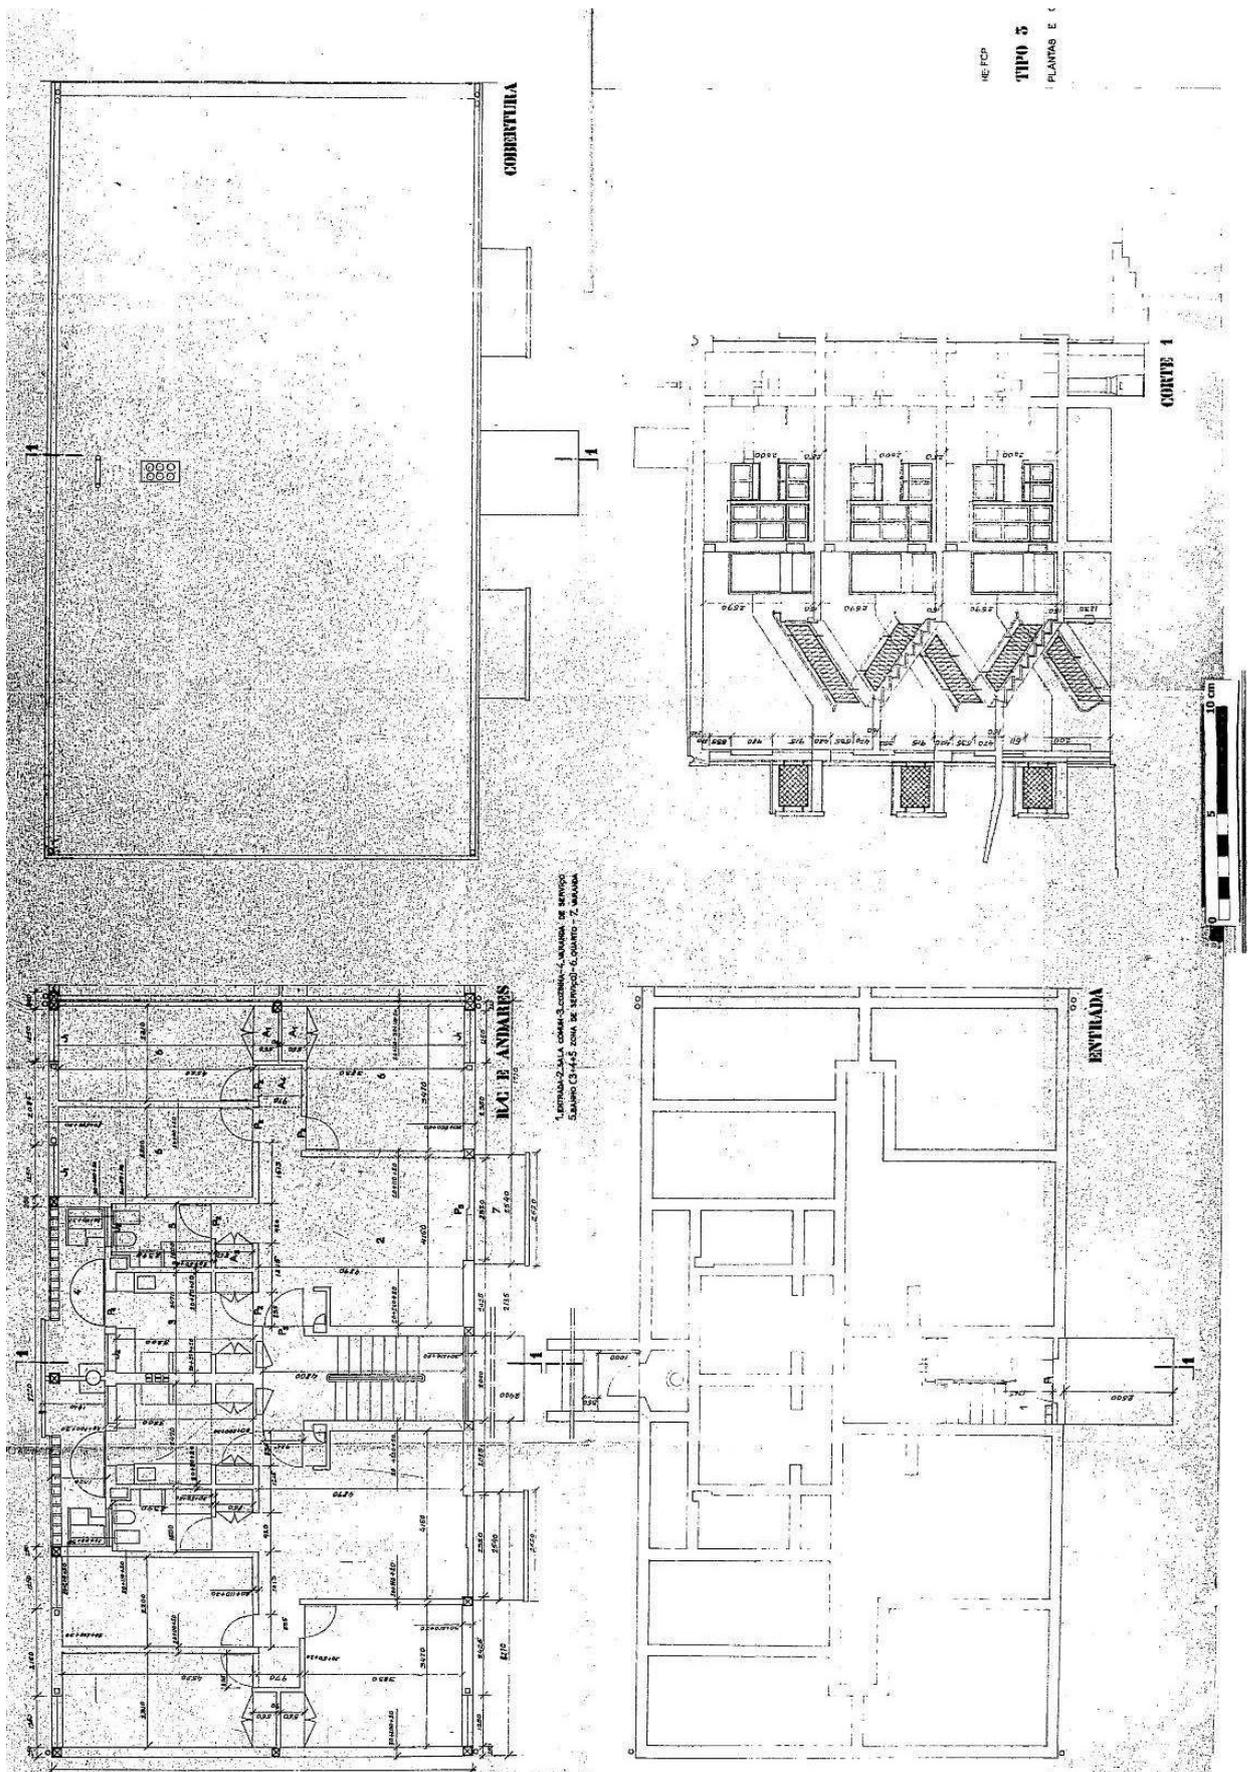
Plantas e corte tipo de um edifício de 3 pisos
